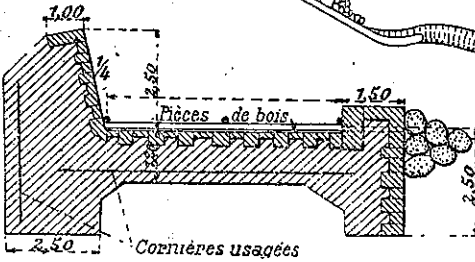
Coupe du canal de prise d'eau de l'usine de Bonnevaux
